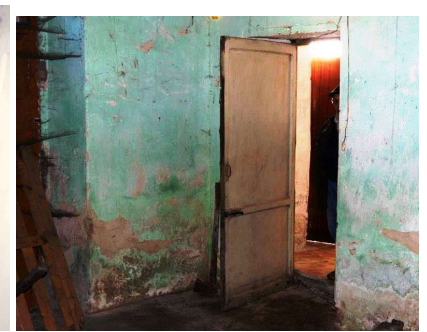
, 8, 9 e 10- accesso ed interno sub 1
